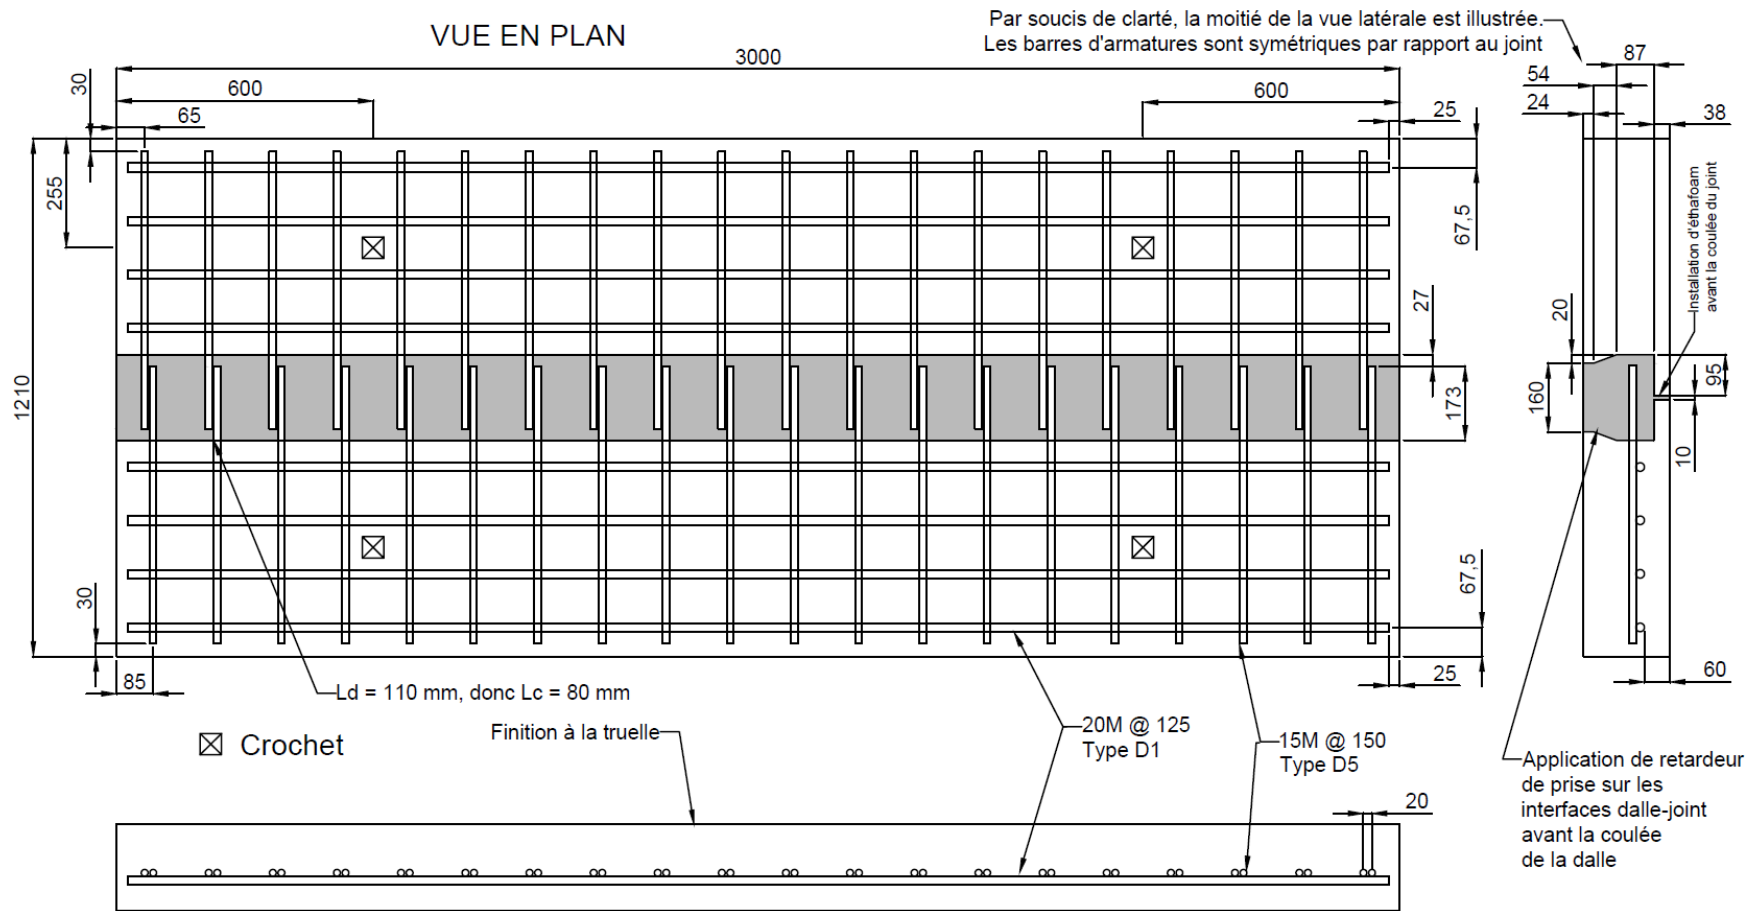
Dalle en BFHP avec joint de connexion transversale (TQC) pour le test cyclique (#3.2)
